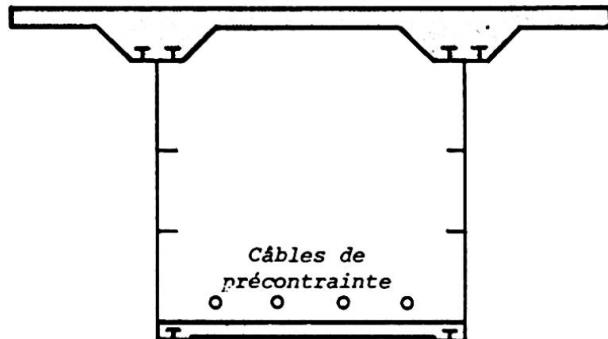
Coupe schématique de la solution à âmes métalliques planes proposée par l'entreprise Fougerolle.
